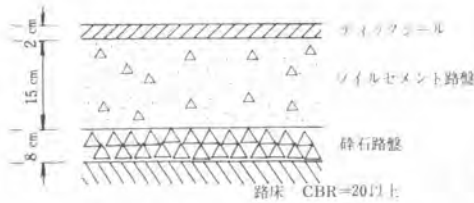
ソイルセメント路盤と薄層舗装の標準断面図
